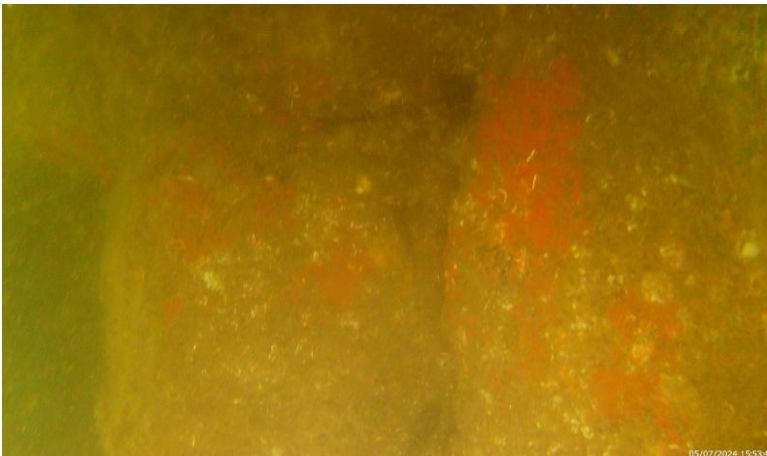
FOTO METRO 344 M DE LOS 847 M. Pilote
